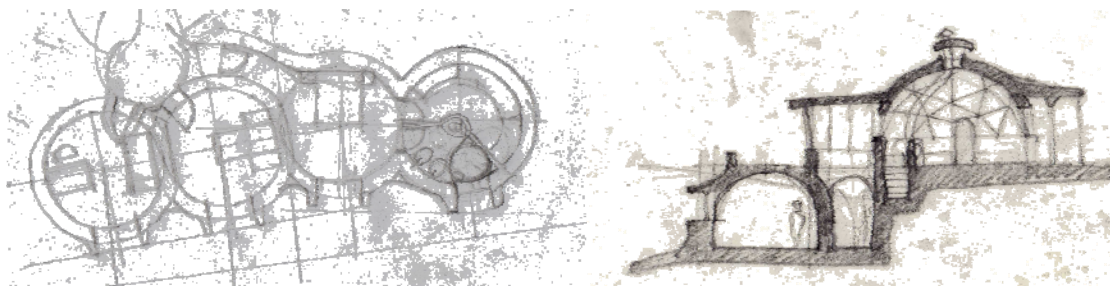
Esquema del proyecto en estudio, planta y corte de la vivienda tipo "iglú".
